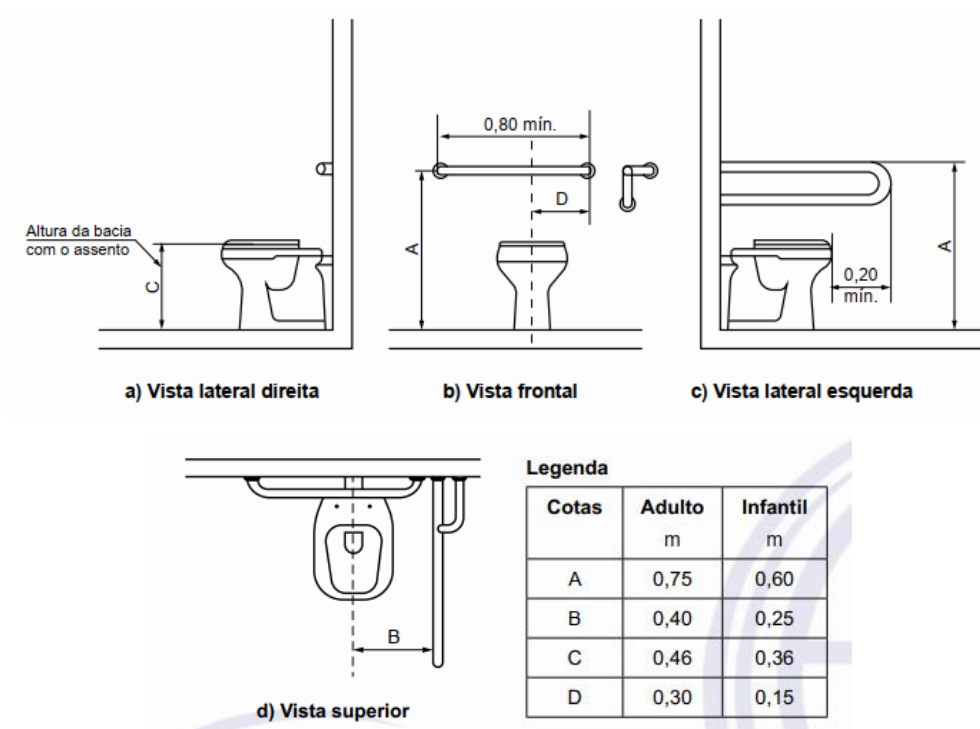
Sem parede lateral – Bacia convencional ou suspensa com barras de apoio reta e lateral fixa – Exemplo A
